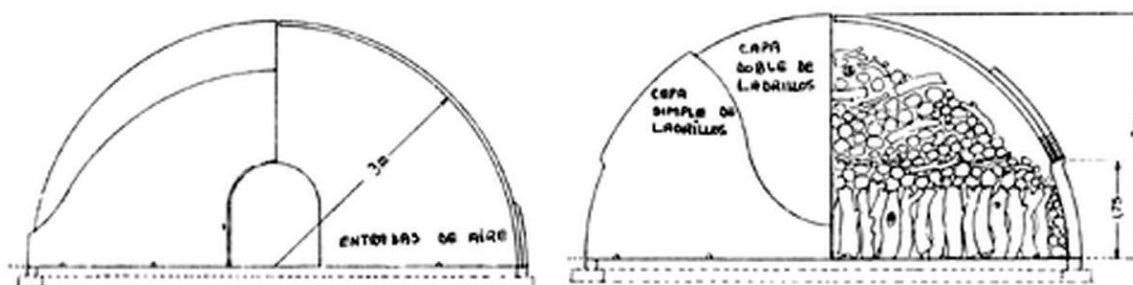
Vista perfil de la izquierda muestra las entradas de aire y las puertas perpendicularmente opuestas y la vista perfil de la derecha muestra
